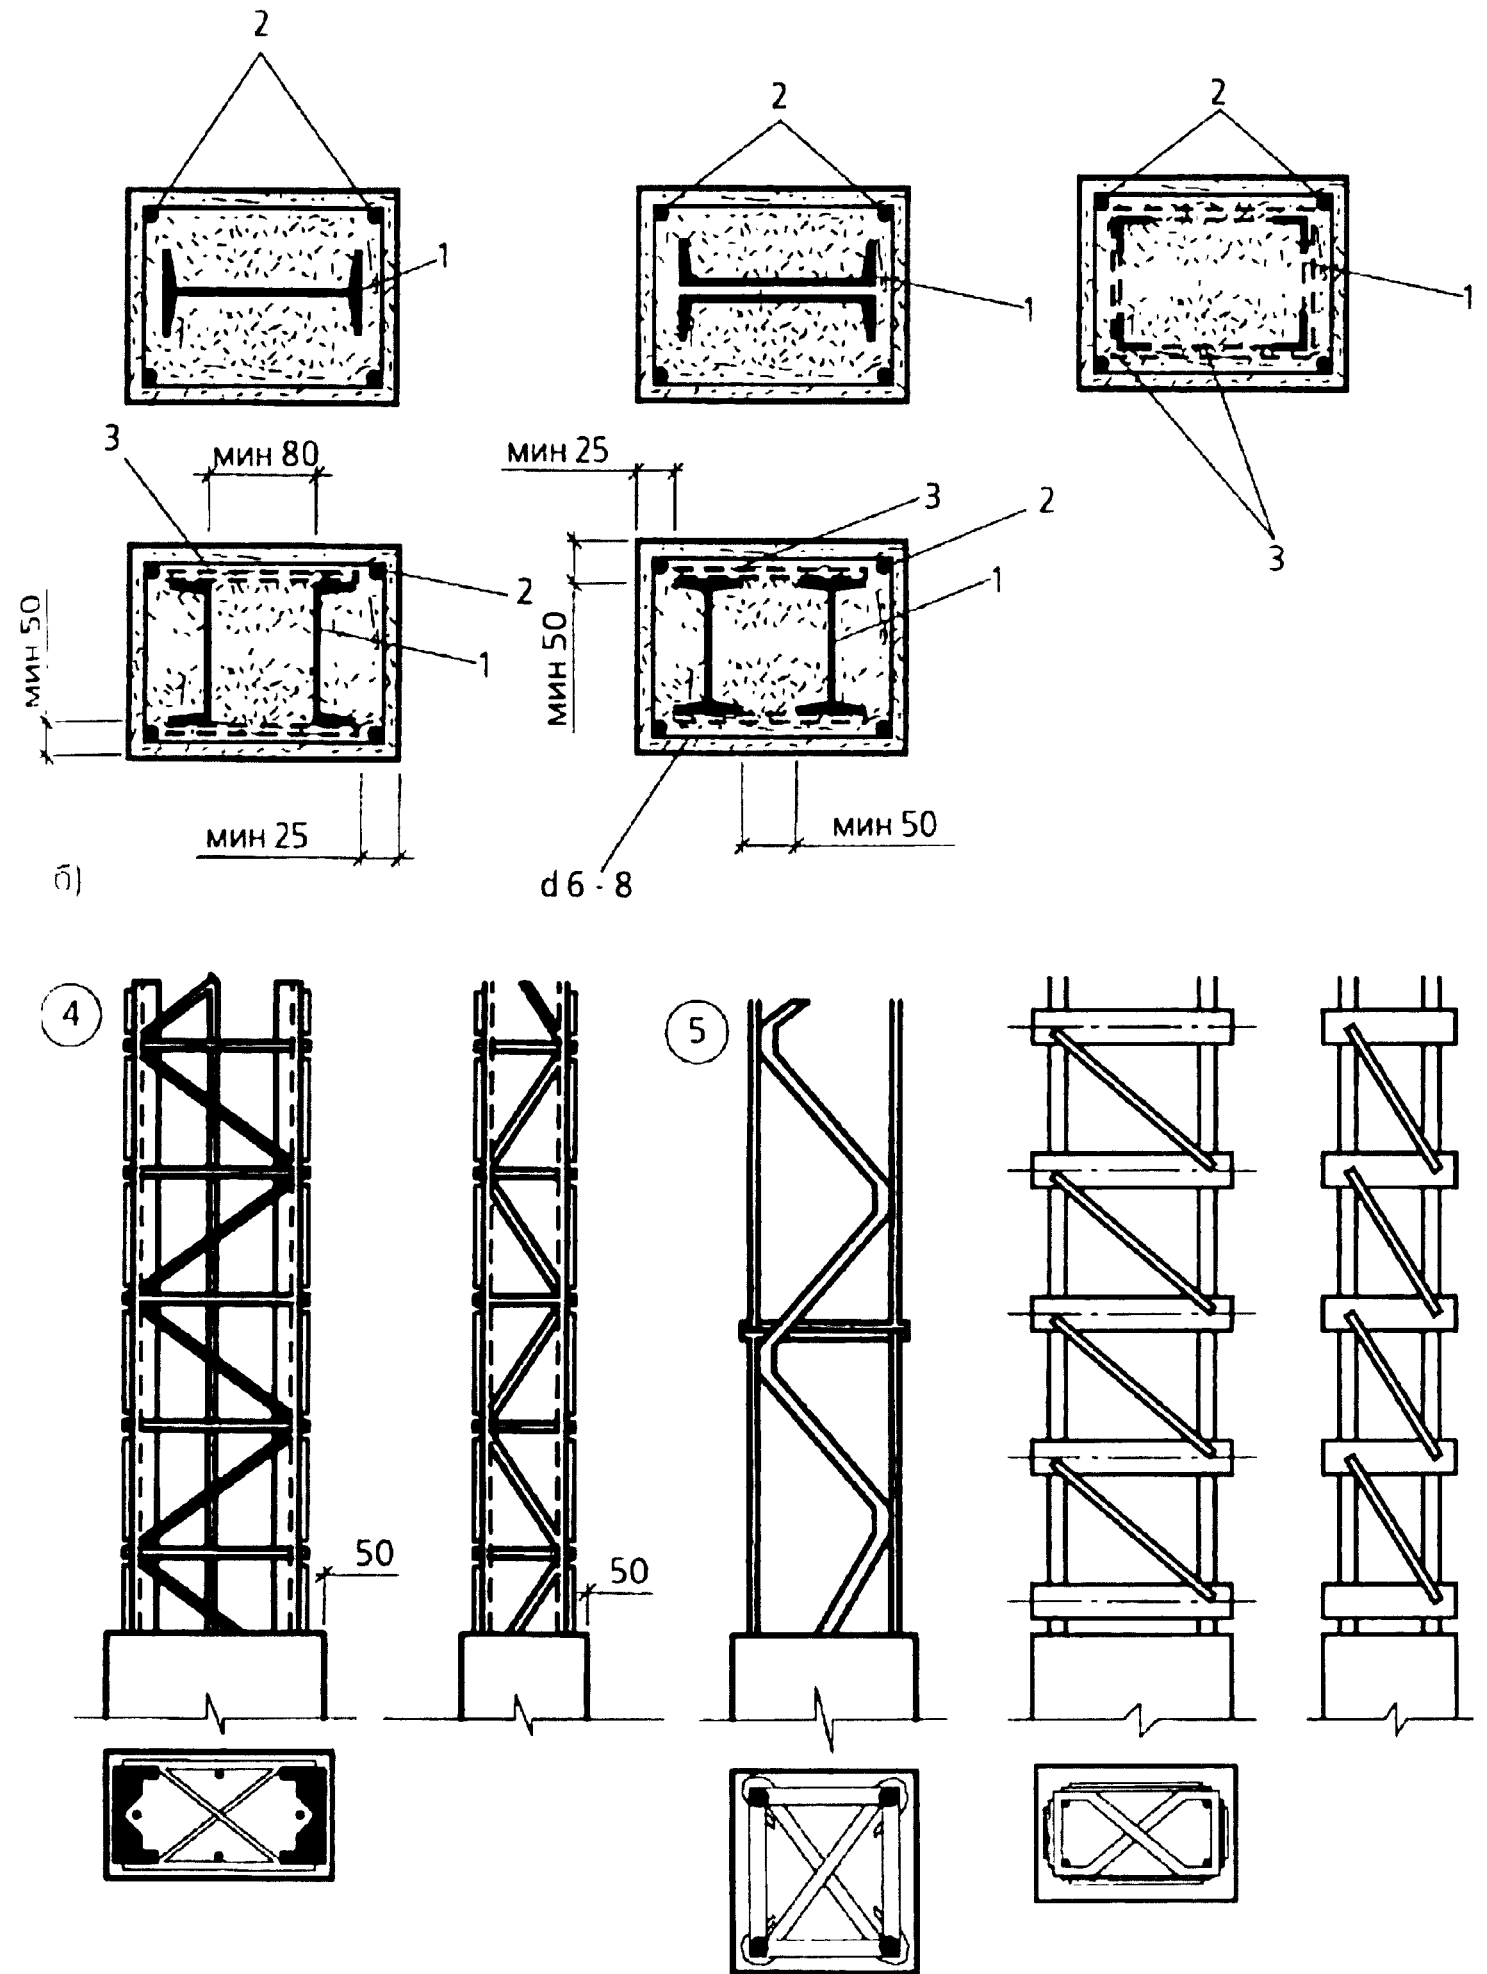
Сжатые элементы: а - колонны с несущей жесткой арматурой; 1 - жесткий профиль; 2 - арматурные стержни; 3 - соединительные планки; б - колонны с несущей арматурой из сварных каркасов, продольные элементы которых выполнены: 4 - из фасонного и круглого проката; 5 - из круглого проката
